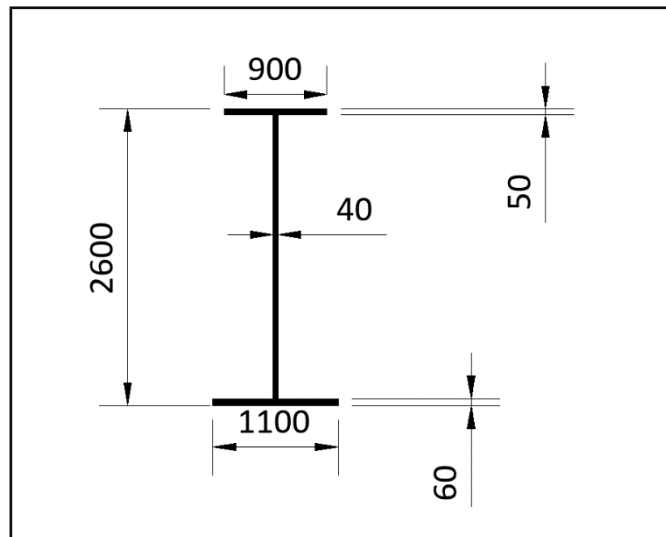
Prédimensionnement de la poutre principale de la variante 2
